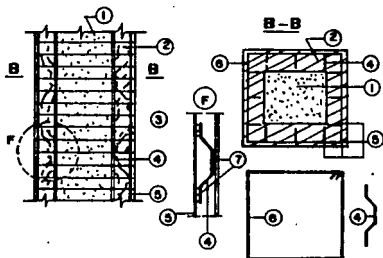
Encamisado completo de columnas con refuerzo repartido uniformemente (Ref. 15)
